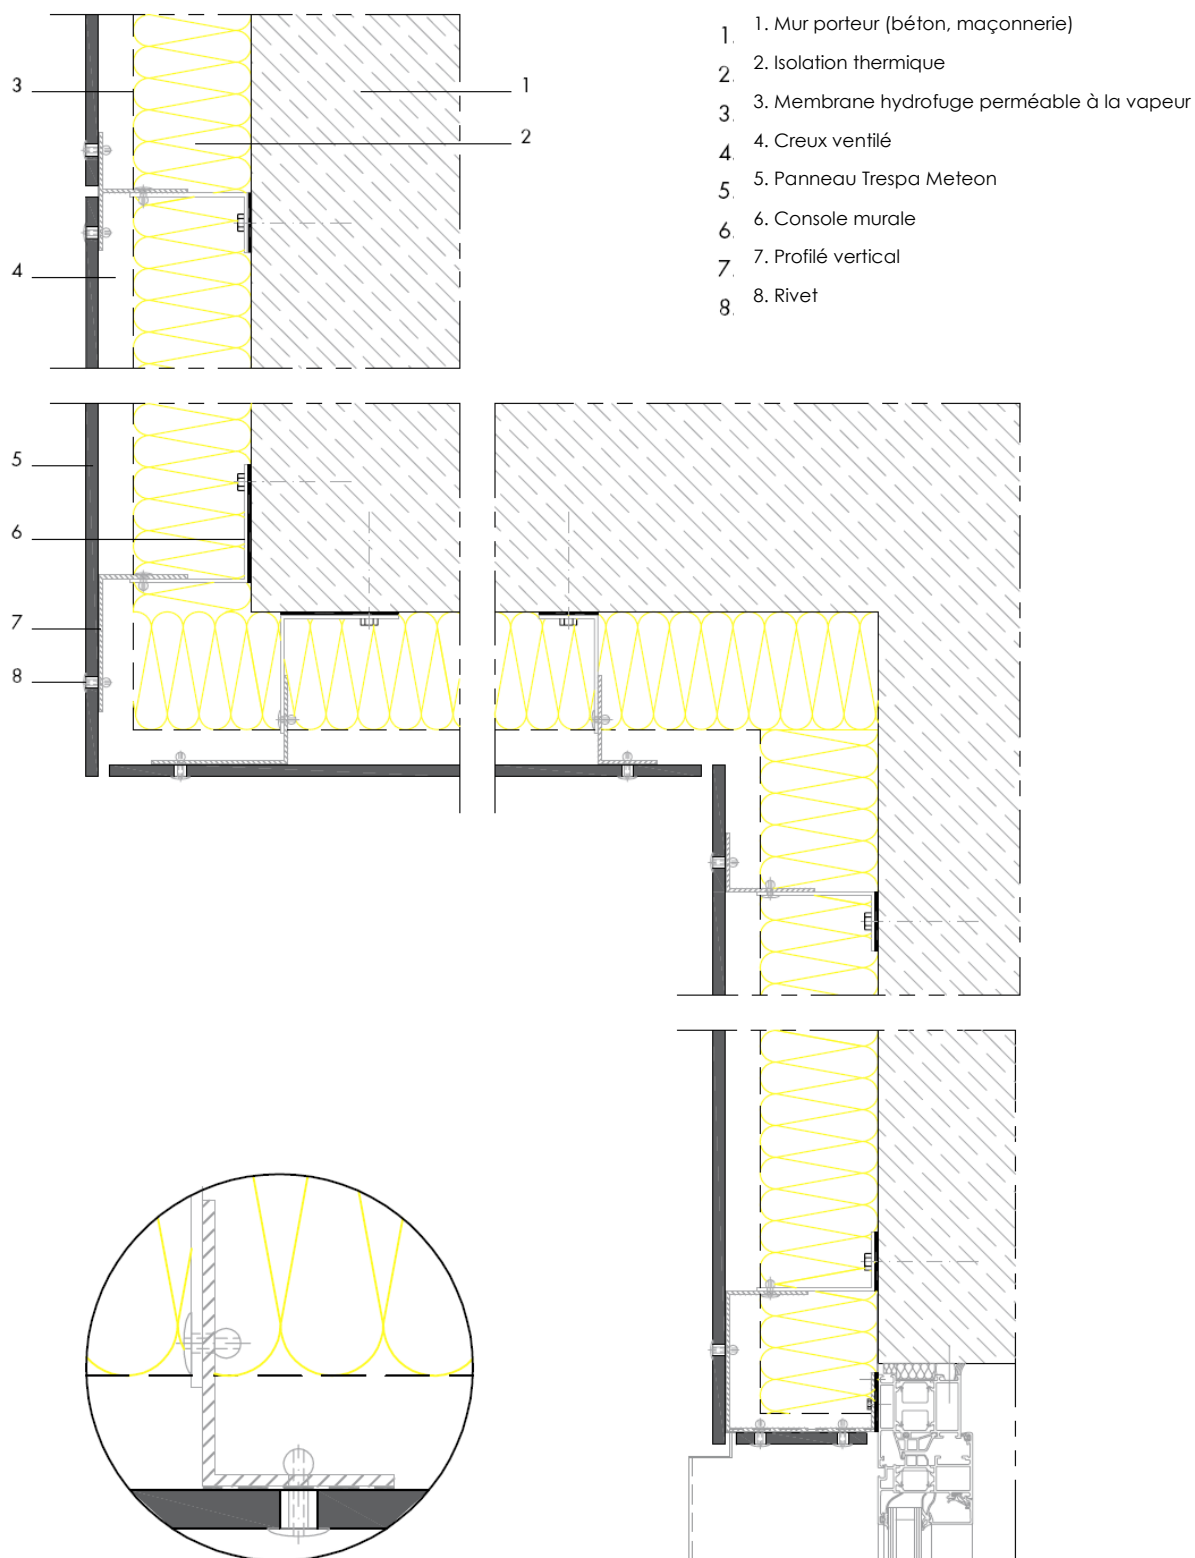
Coupe verticale d'une fixation de panneau avec rivets
